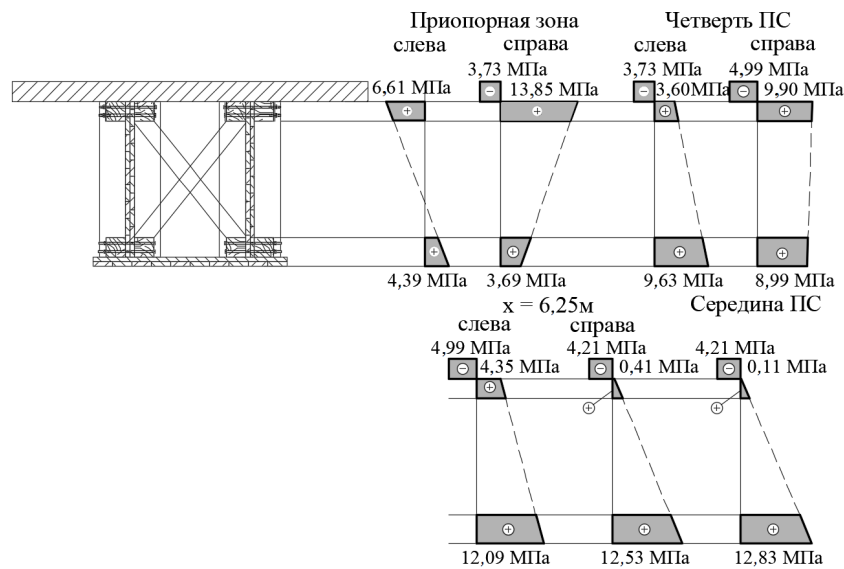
Эпюры нормальных напряжений в характерных сечениях комбинированного пролетного строения с дощато-гвоздевыми блоками и железобетонной плитой проезжей части (ПС – пролетное строение)
